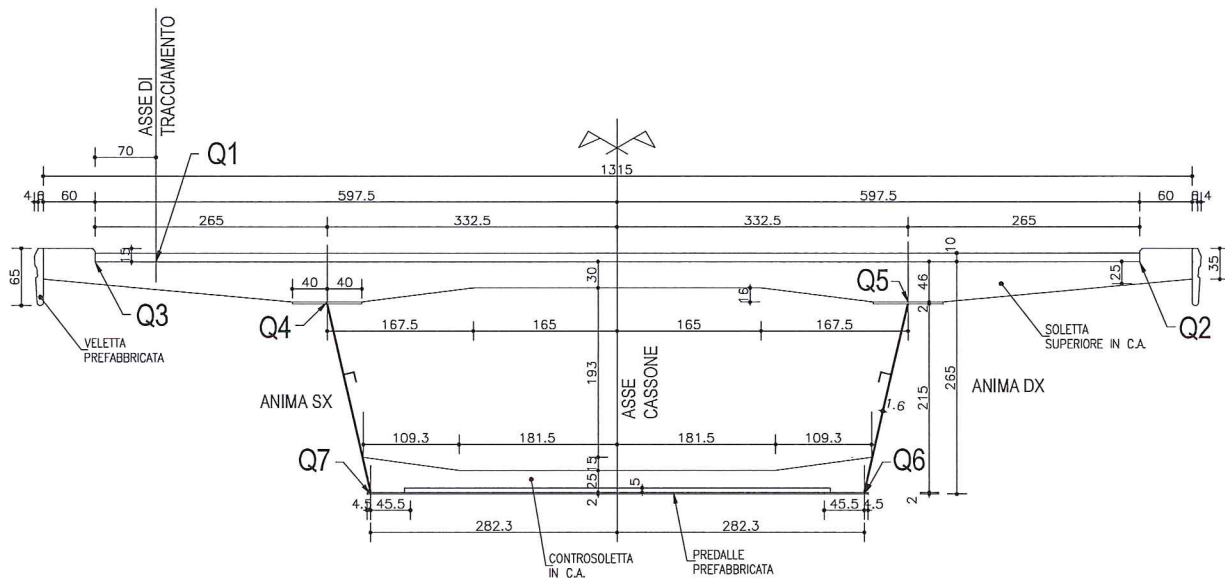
Concio di chiave – Sezione trasversale impalcato di larghezza 13.15 m.
